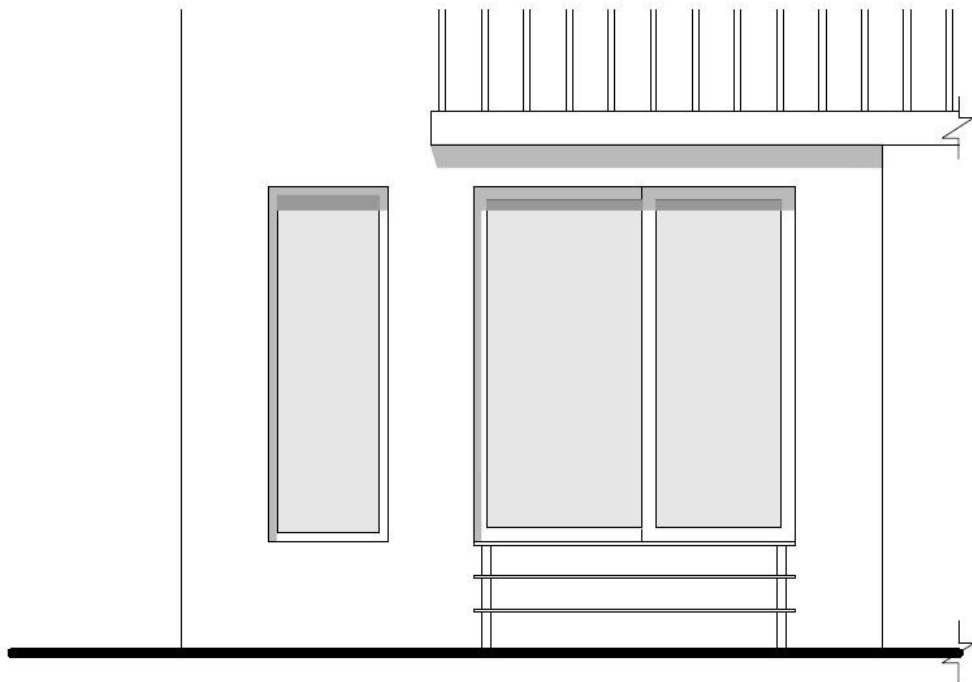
Fachada propuesta. Elaboración: Autor
